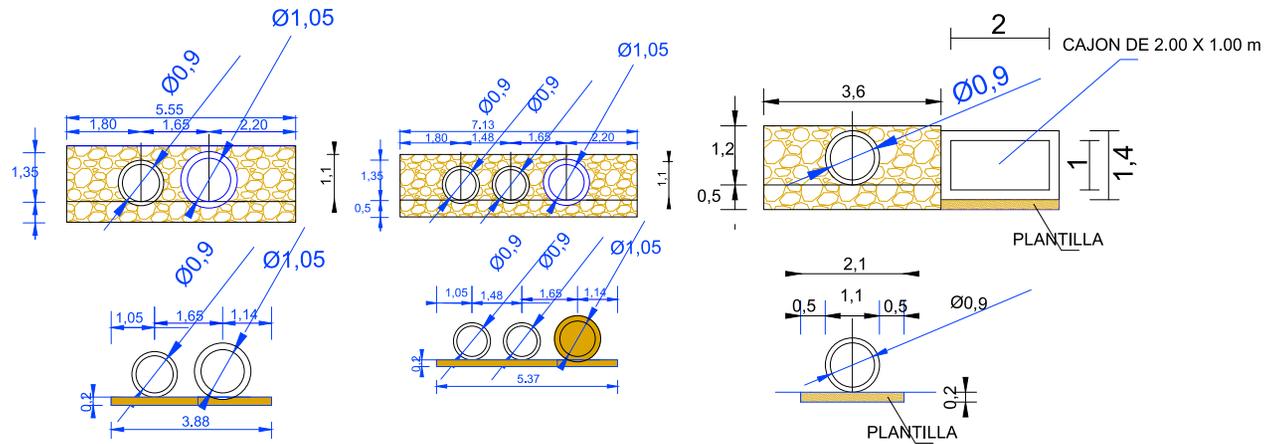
Secciones estructurales con dos o más tubos en dimensiones combinadas (0.90 y 1.05 m)
